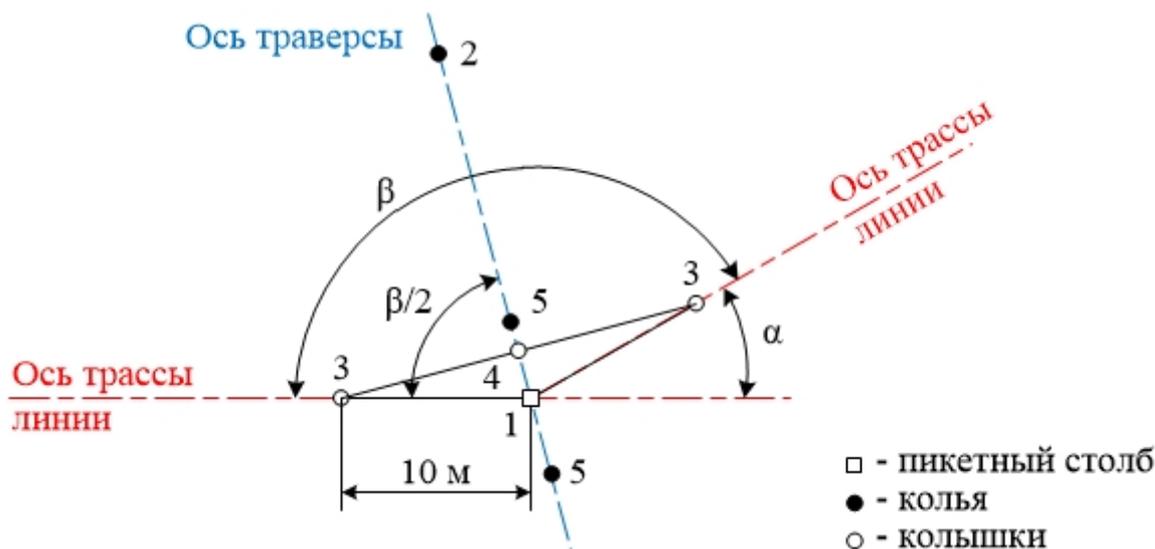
Схема разбивки котлованов для железобетонных одностоечных и двухстоечных анкерно-угловых опор
